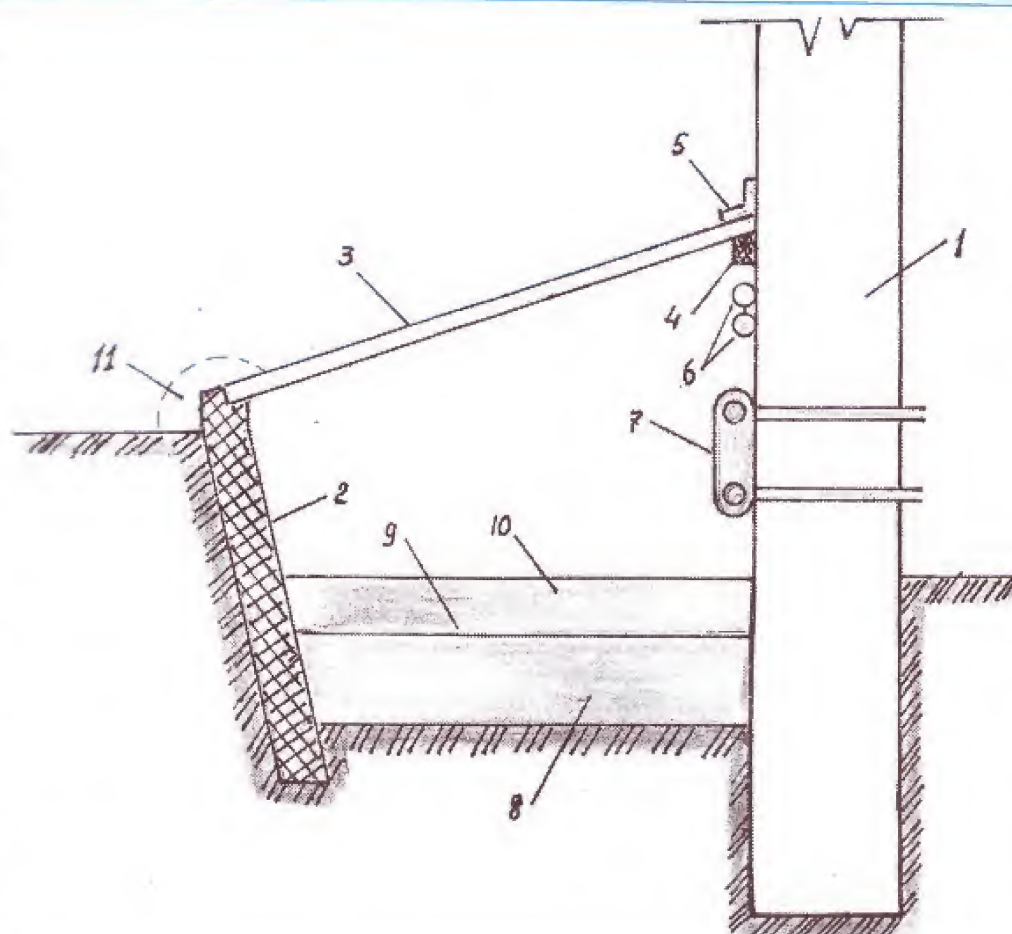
Пристінна односкатна теплиця: 1 — стіна будинку; 2 — бетонний фундамент котлована; 3 — засклена або обтягнута плівкою похила рама; 4 — упорний брус; 5 — захисний козирок; 6 — лампи денного освітлення; 7 — батареї опалення; 8 — біопаливо; 9 — гашене вапно (пушонка) або деревний попіл; 10 — поживний ґрунт; 11 — шар гною чи солом'яні мати на зимовий період
